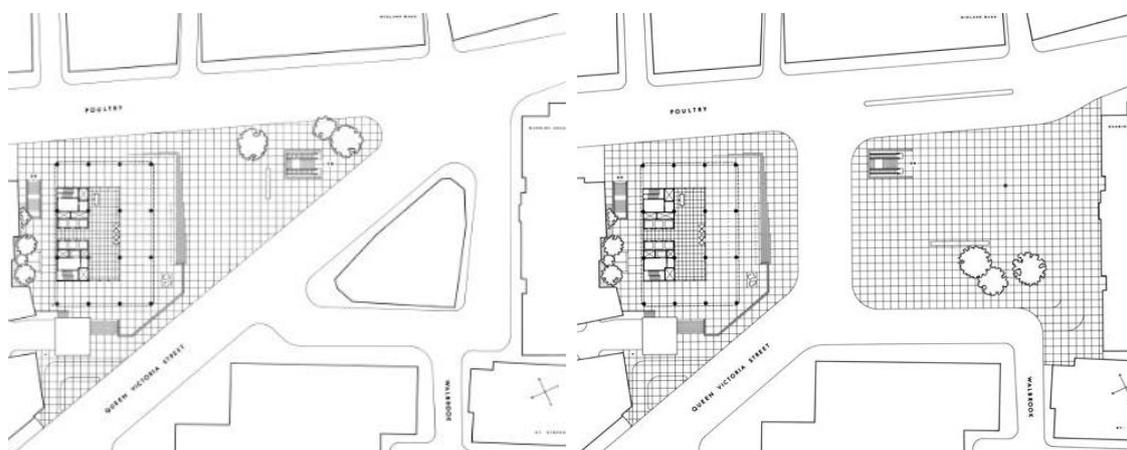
Planta do existente da torre para Londres, Hedrich-Blessing, 1967. (Carter, 2007, p. 149).
